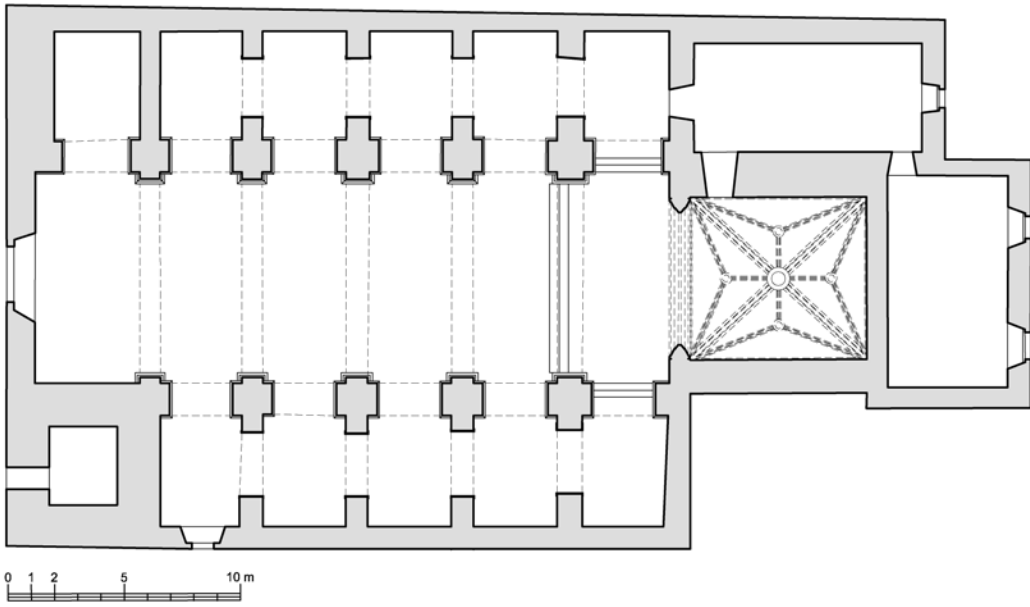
Pianta con la proiezione a terra delle nervature delle volte
